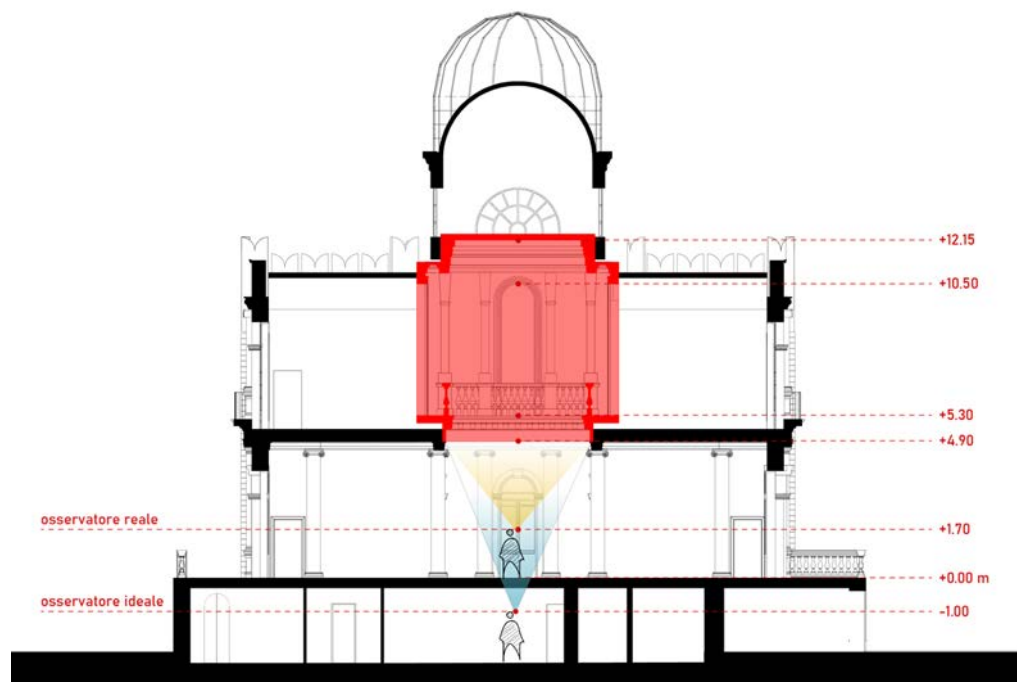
Sezione longitudinale dell'ambiente pittorico 3D nel modello BIM della Villa.
